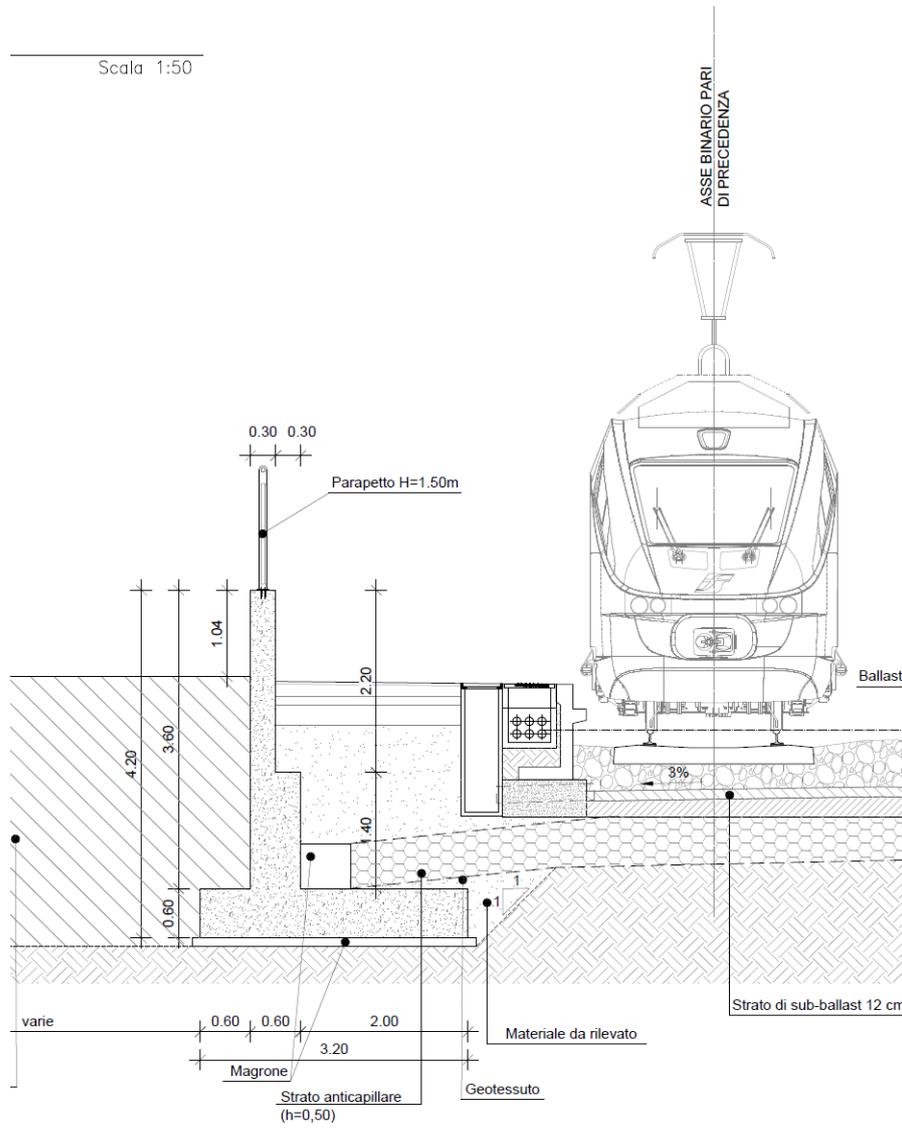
Muro Tipo B – Sezione trasversale tipo H420 cm
